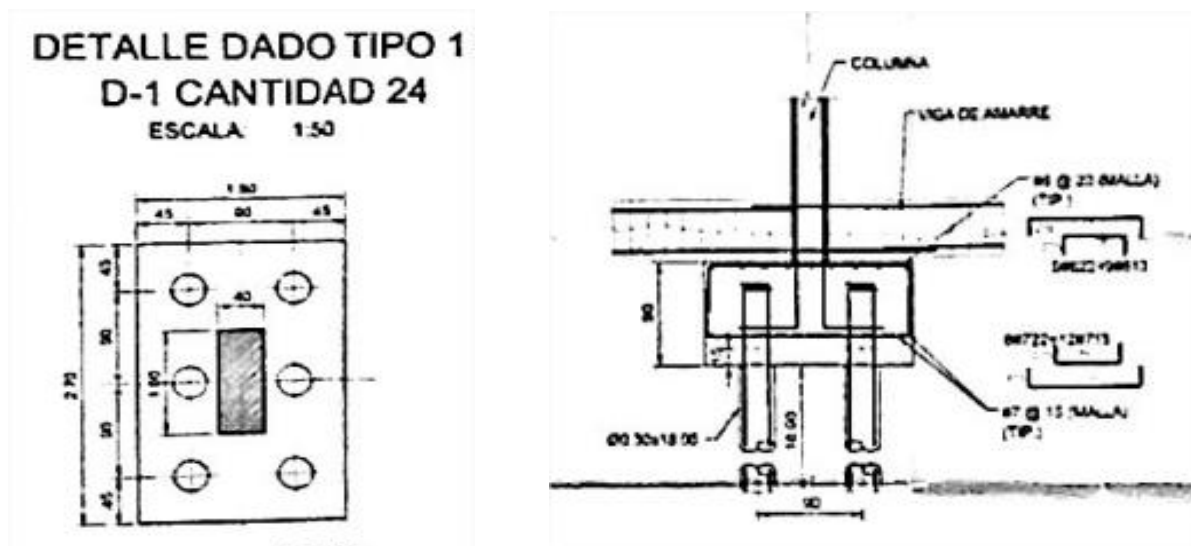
Detalle cimentación aplicada a los pórticos en concreto.
